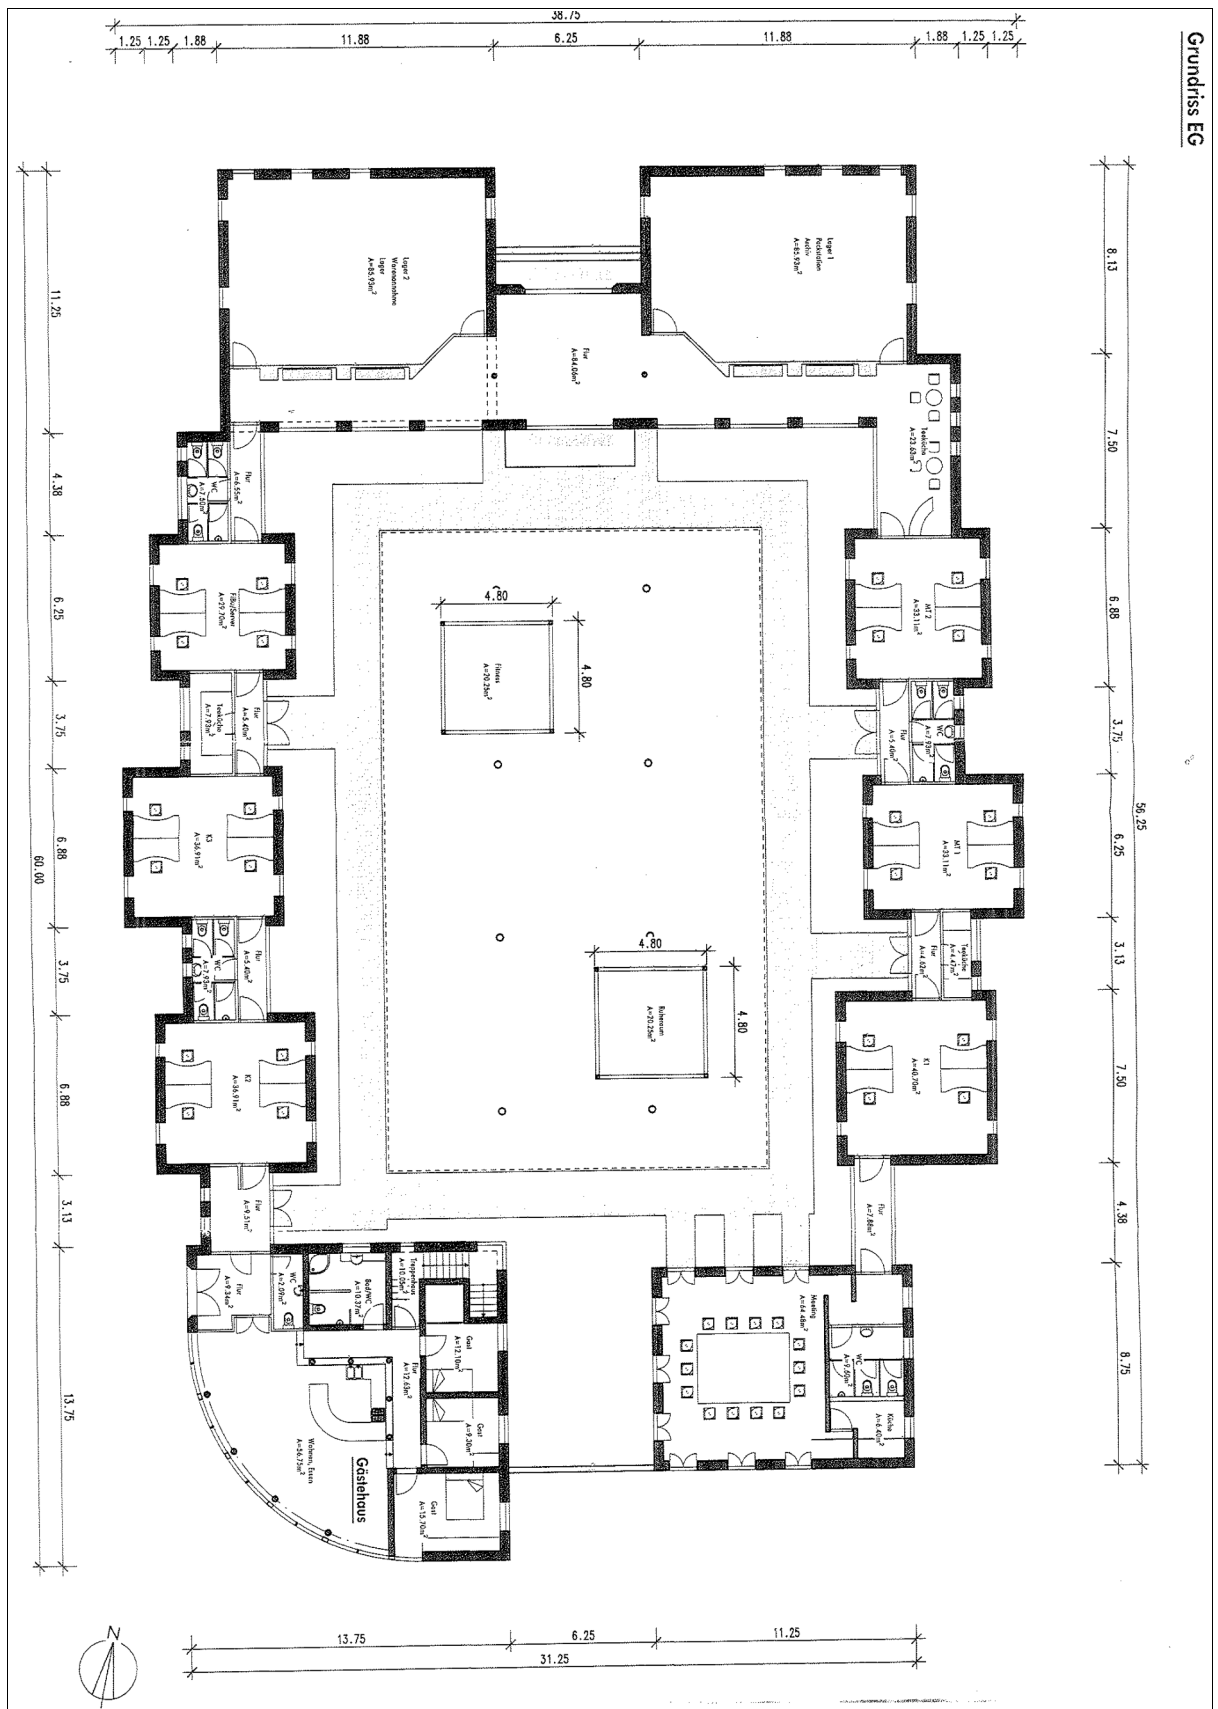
Grundriß Erdgeschoß des Gebäudes P.M.C.
